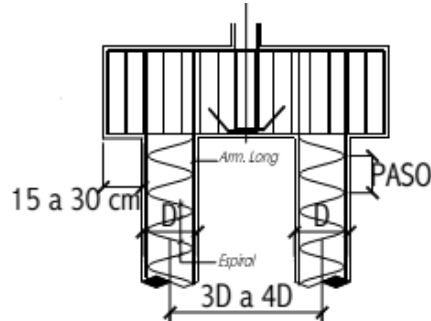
Medidas consideradas en el cálculo de un cabezal de pilote.
